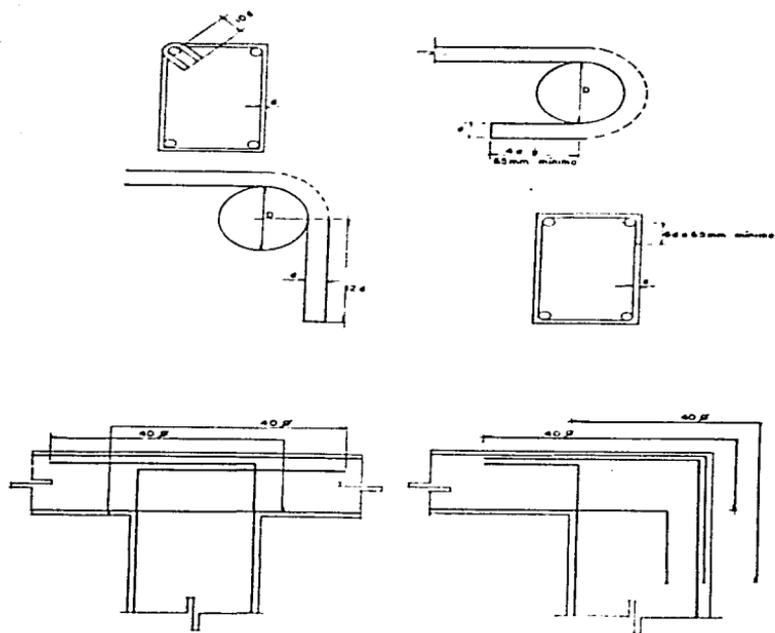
Detalles de ganchos estandar y tipo de refuerzo
